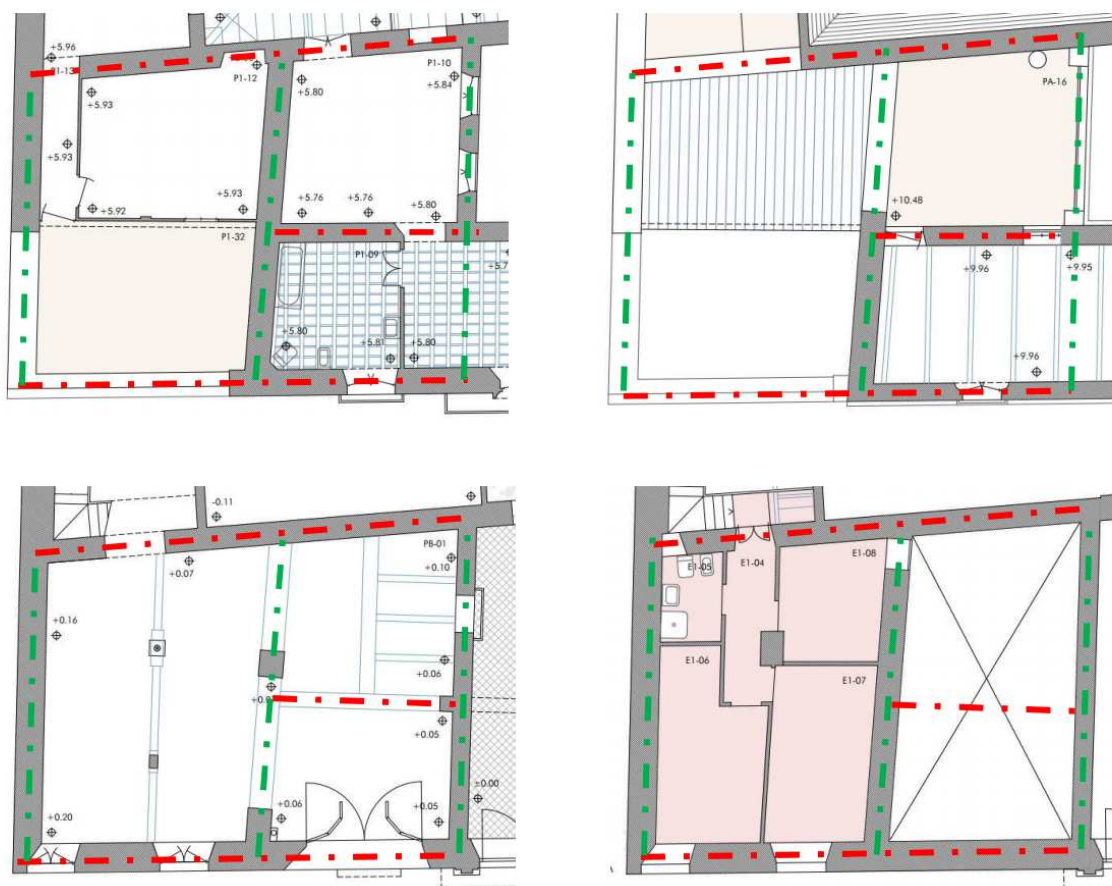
De izquierda a derecha y de abajo a arriba, ejes de muros de la zona de la cochera paralelos a fachada (en rojo) y paralelos a medianera (en verde), sobre plano de planta baja, entreplanta, alta y de cámaras.
